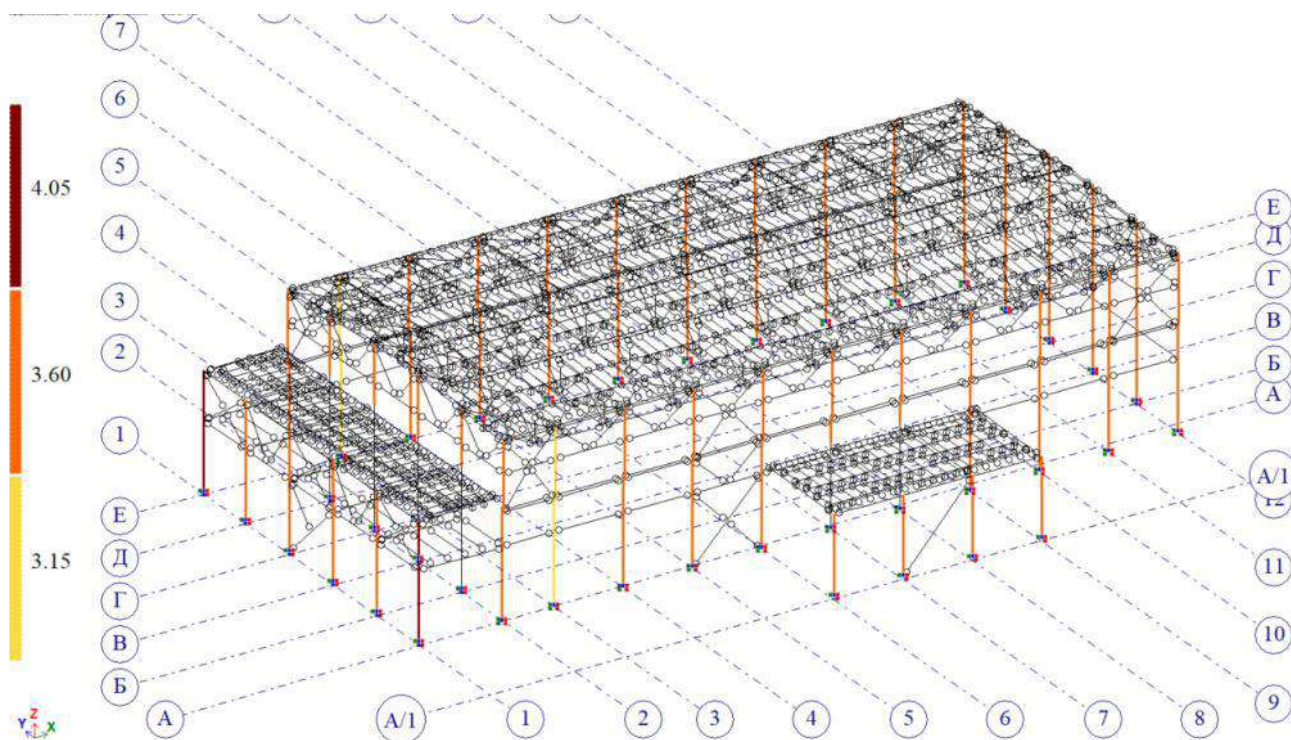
Нагрузка от собственного веса конструкции наружных стен, кН/м
